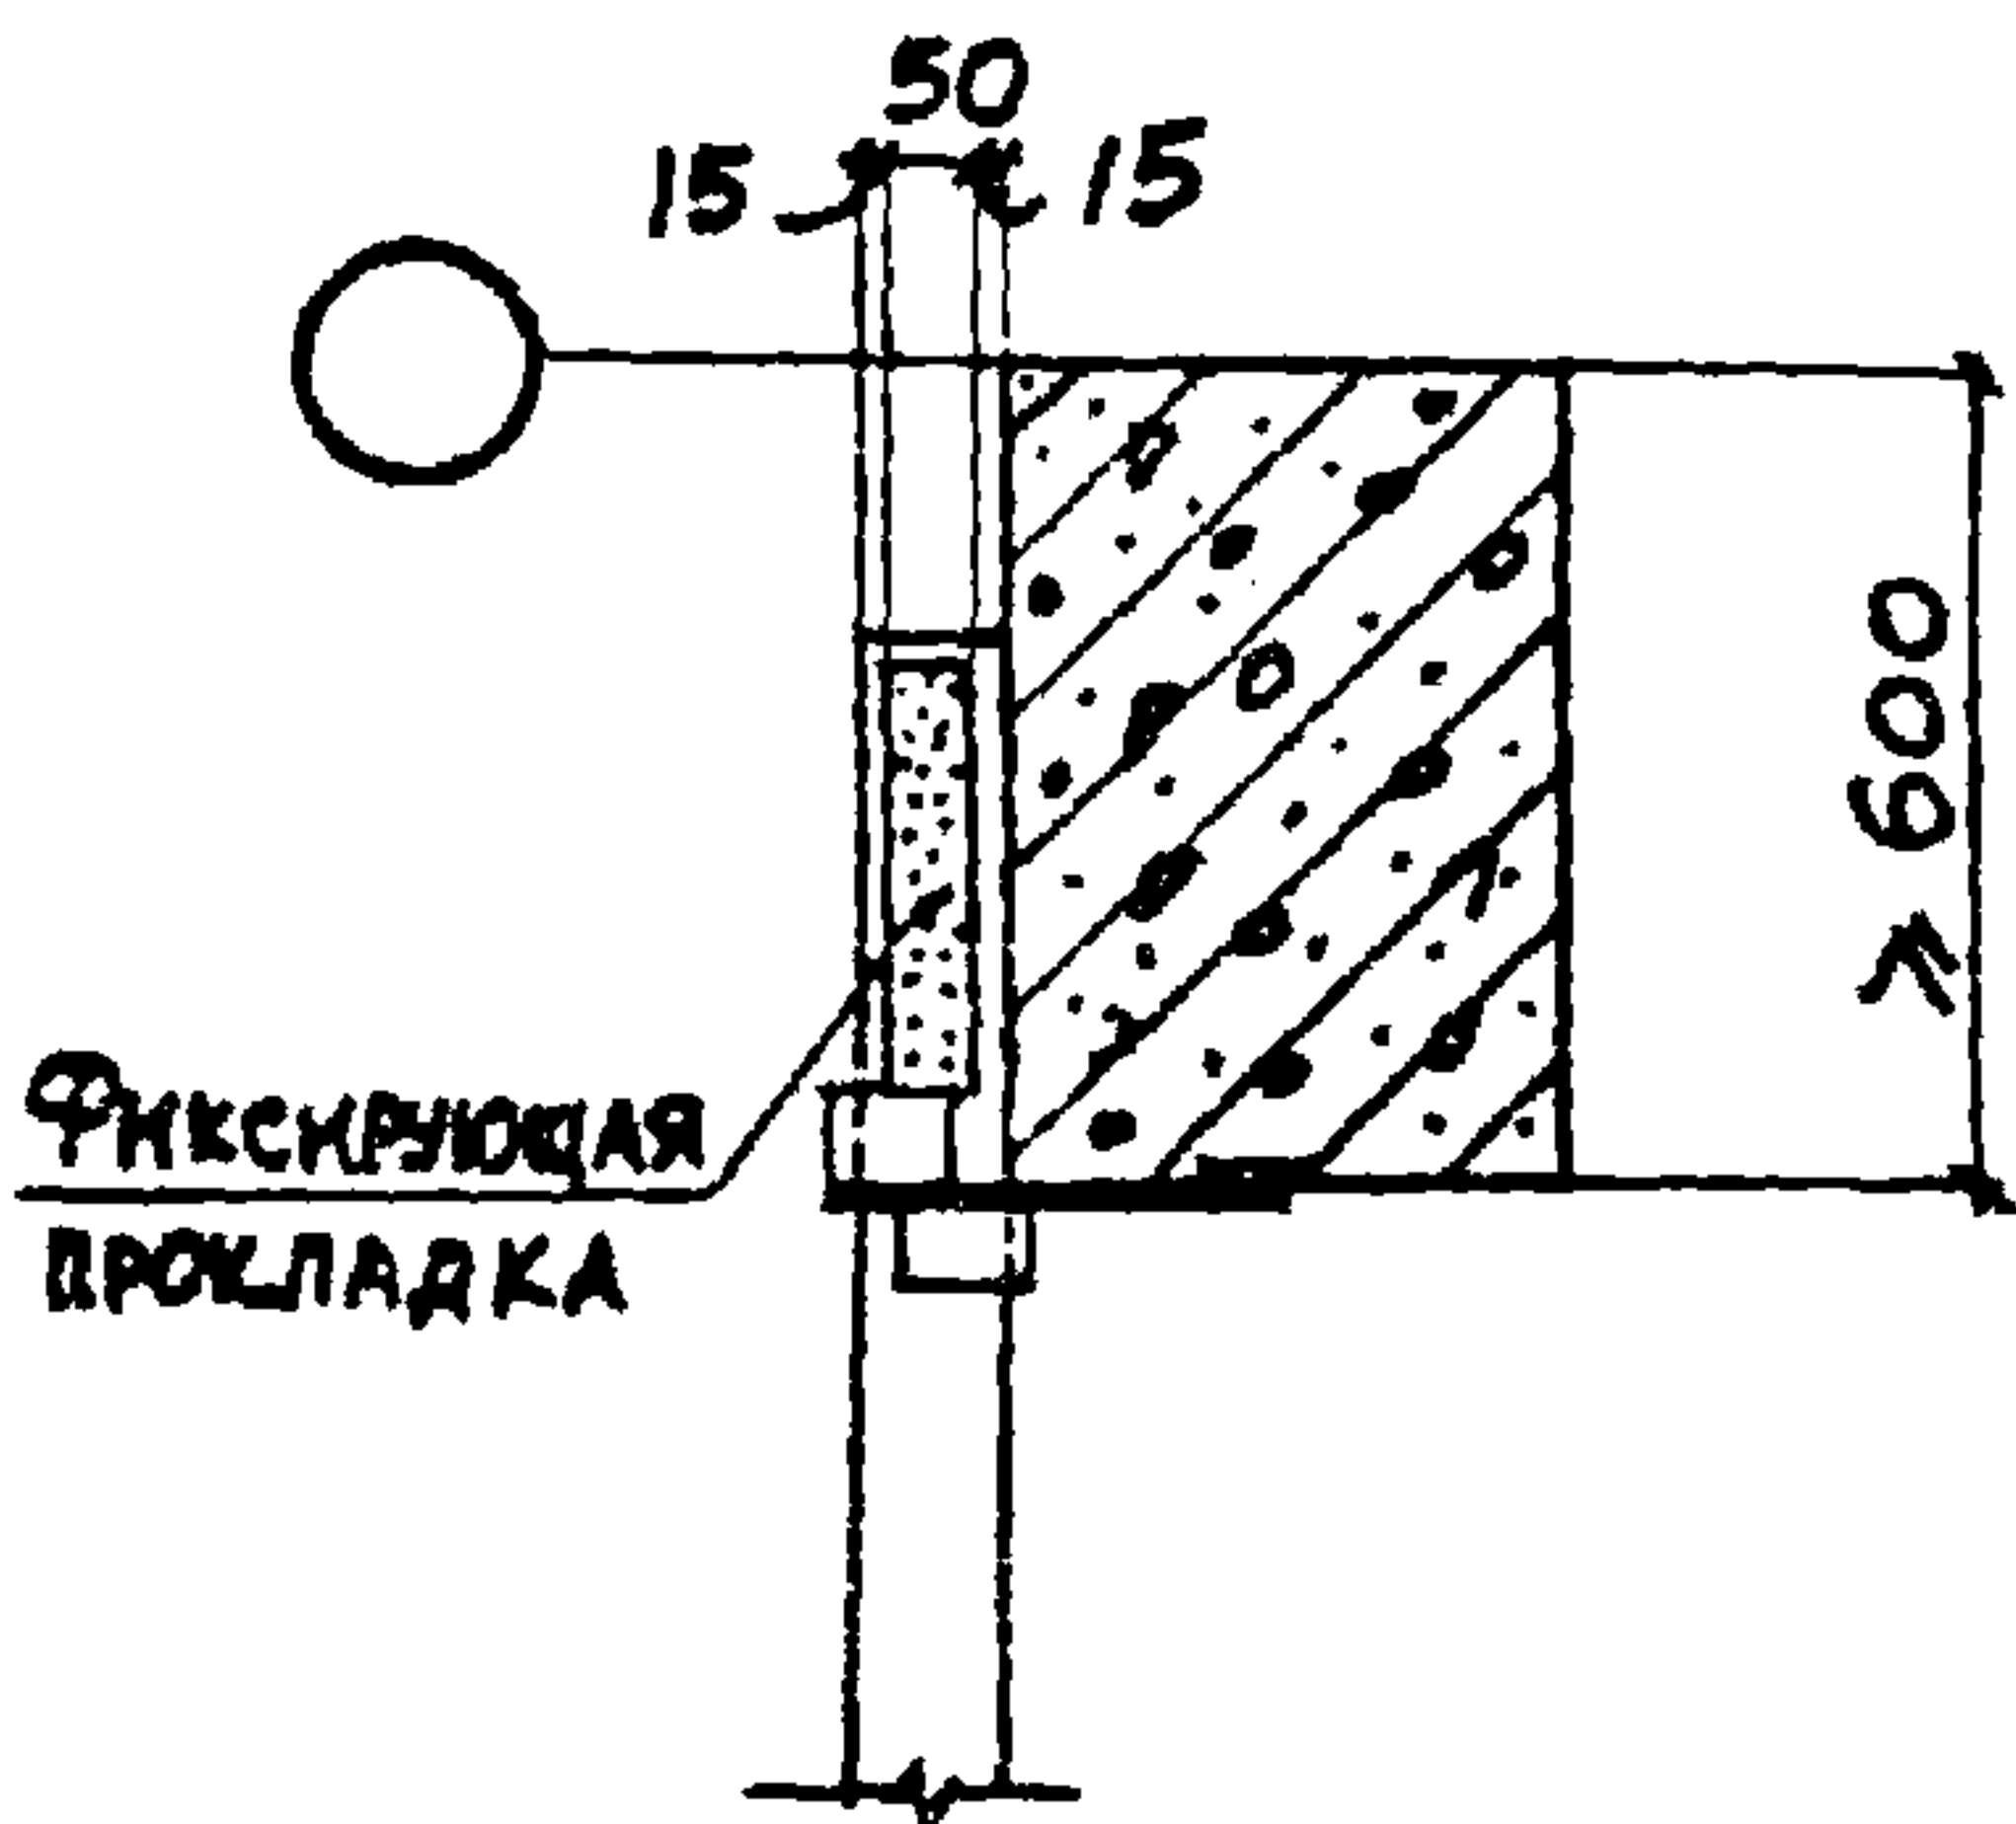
В поперечных перегородках у крайних колонн здания с высотой сечения колонны ≤ 500
